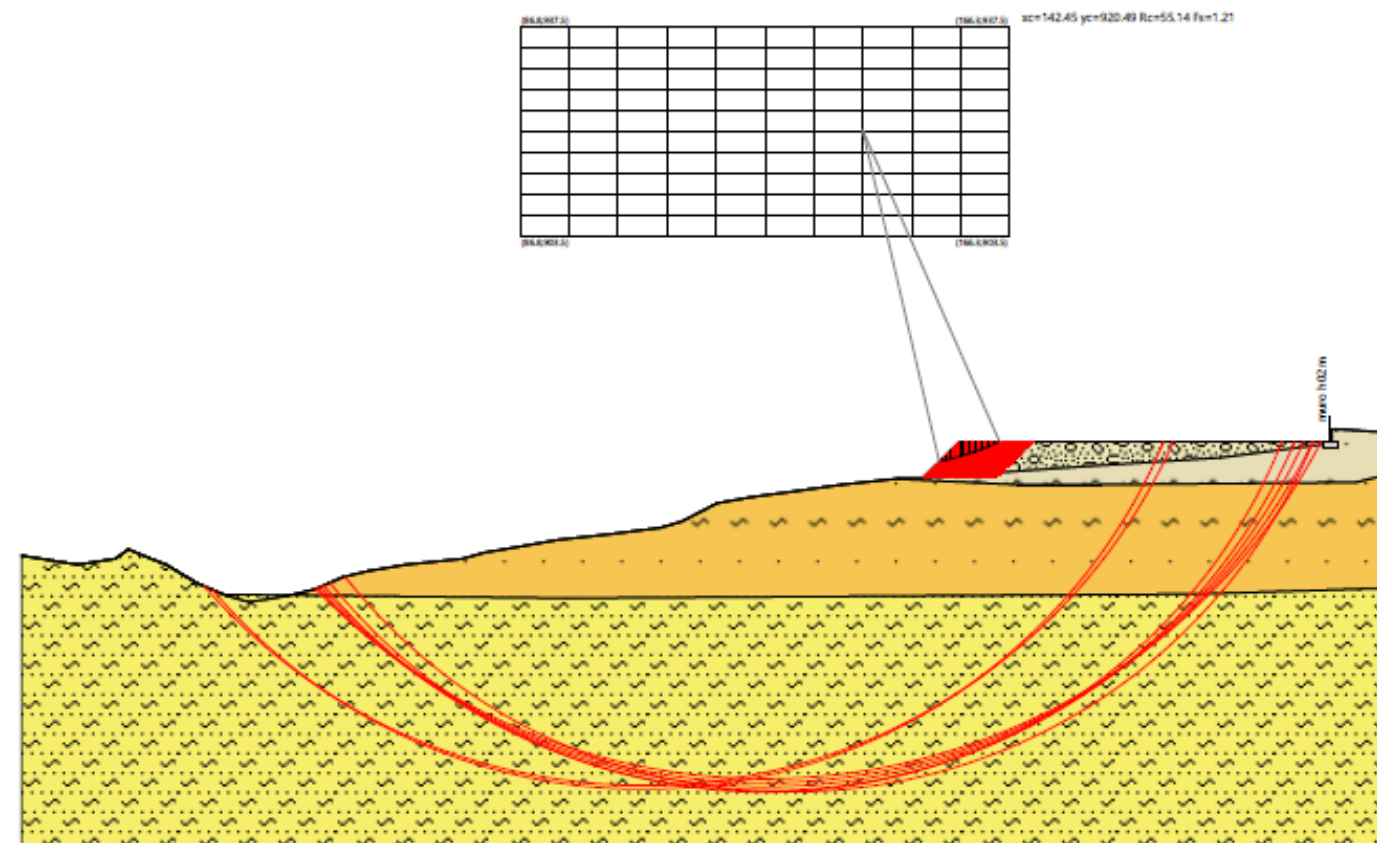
SEZIONE VERIFICA STABILITÀ – STATO DI PROGETTO
